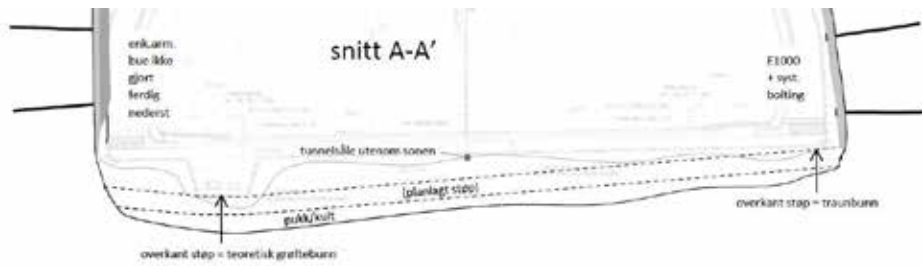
er en serie illustrasjoner for å vise etablering av en enkel, plan støp begrenset til selve svakhetssonen.
